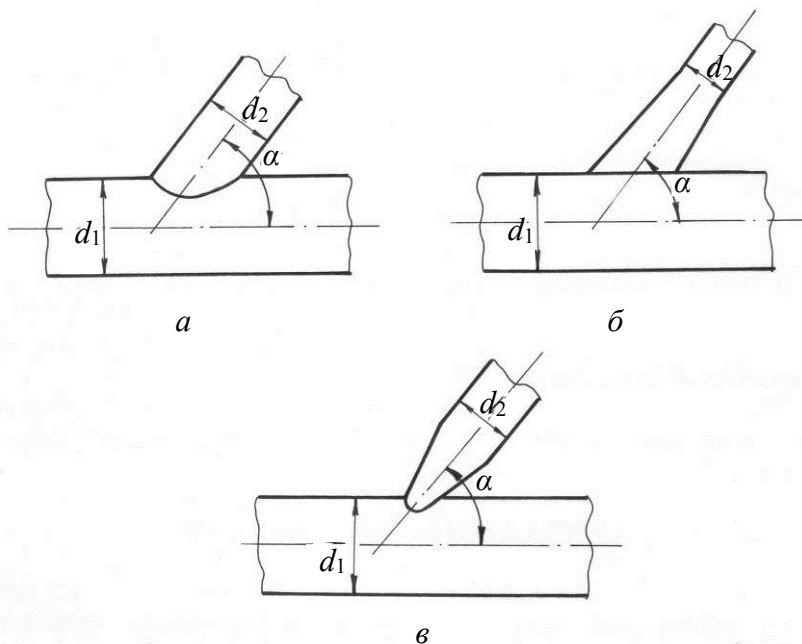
Схеми зварних з'єднань між трубчастими розкосами і поясами
